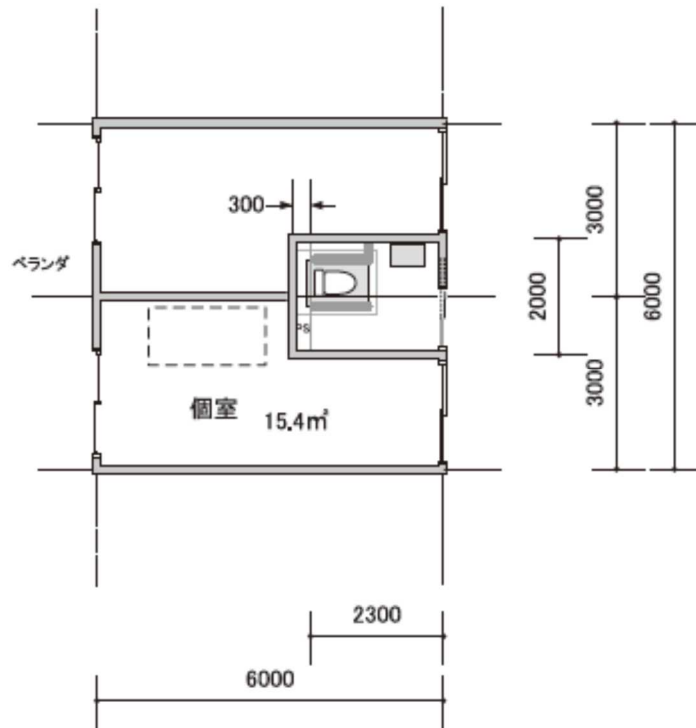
0 モデル建物（福祉施設等） 個室詳細平面図
